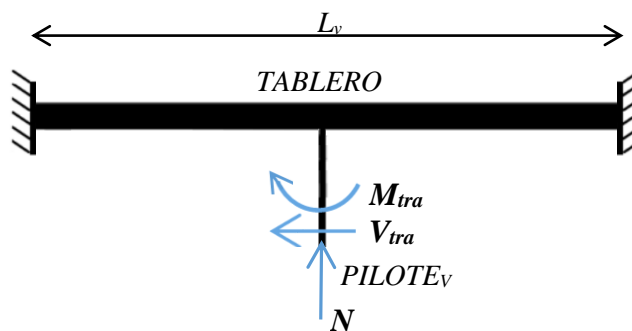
Conexión aislada de estructura con sistema de apoyos de empotramiento.
